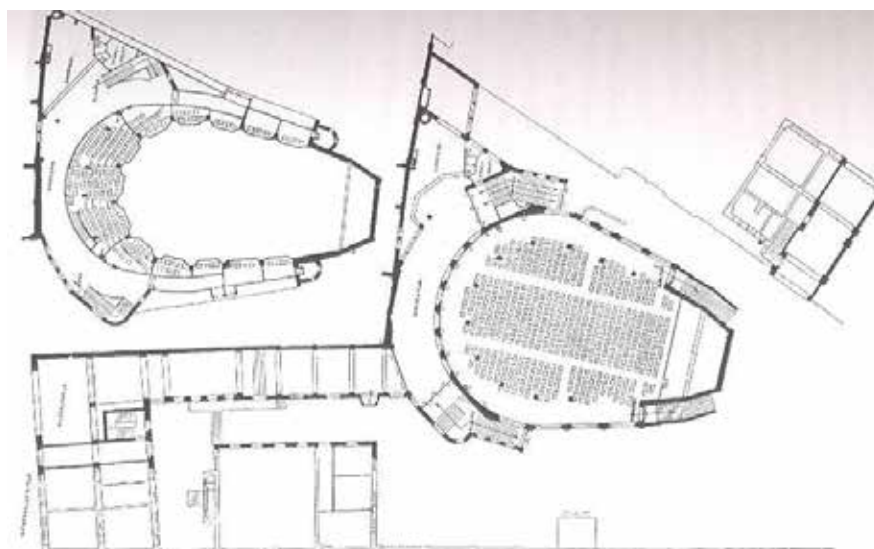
pianta galleria e platea Martin Pietzsch Union di Dresda
